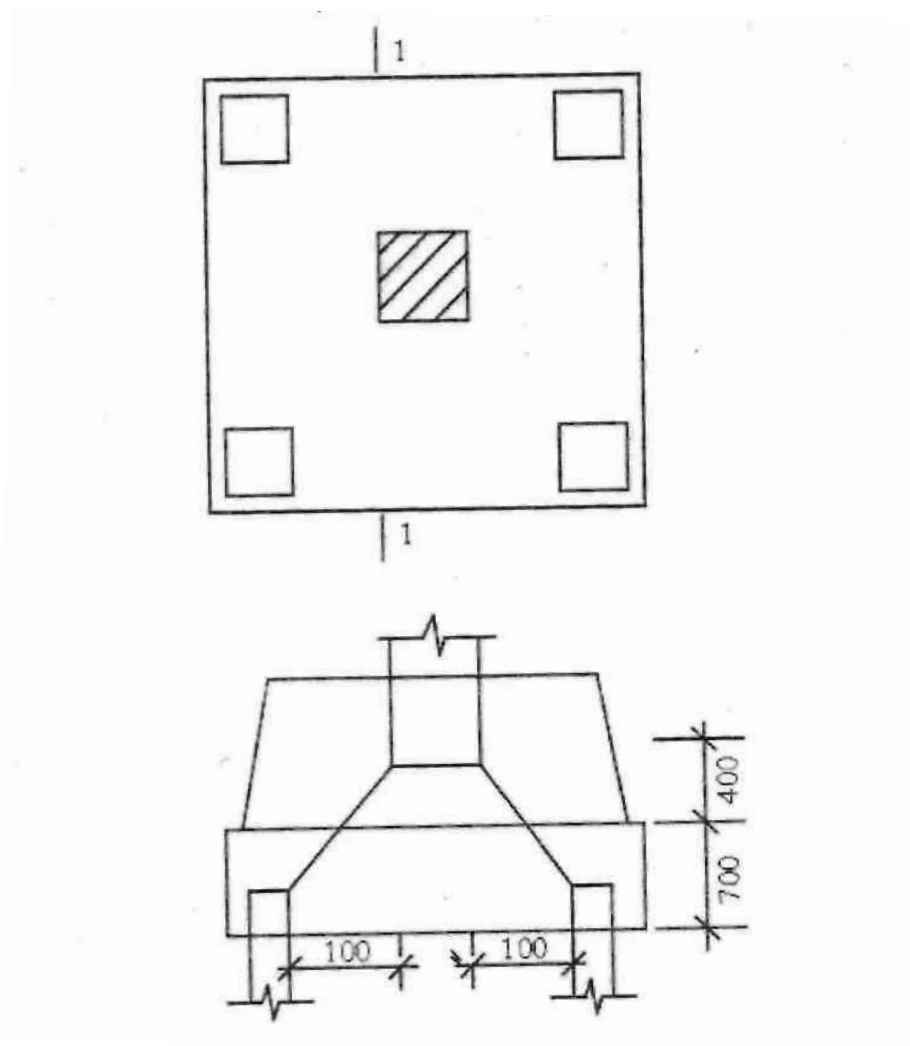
Розрахунок ростверка на продавлювання колоною.
